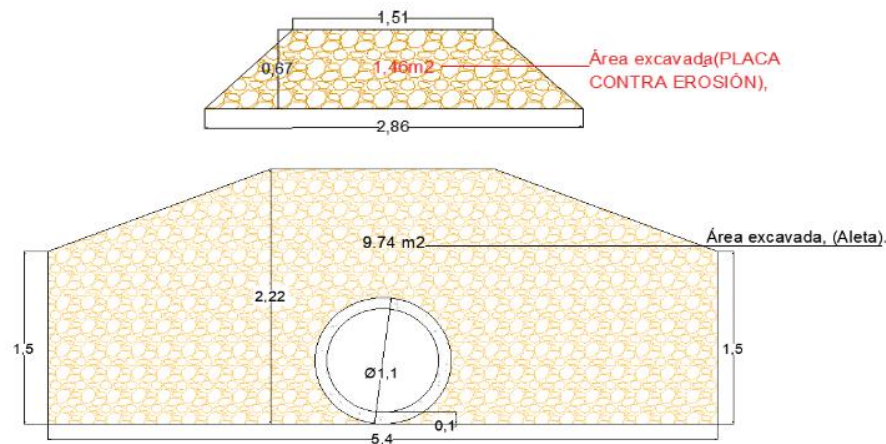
SECCIÓN EXCAVACIÓN ALCANTARILLA
